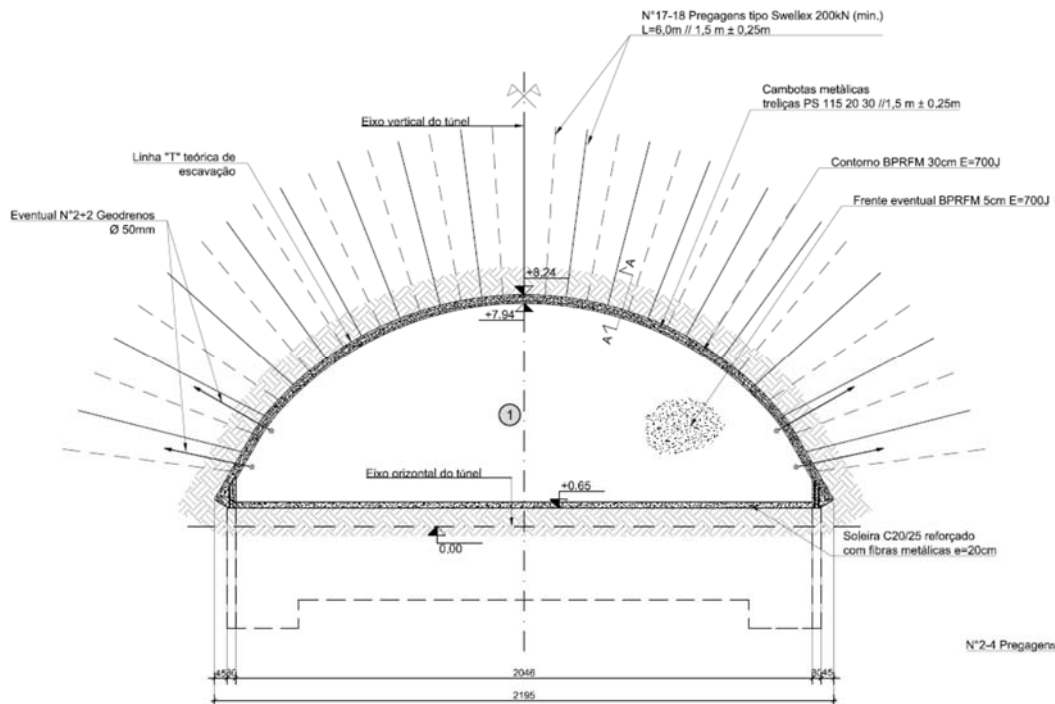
Seção tipo da fase 1 – calote superior - escavação e suporte primário em ZG2
